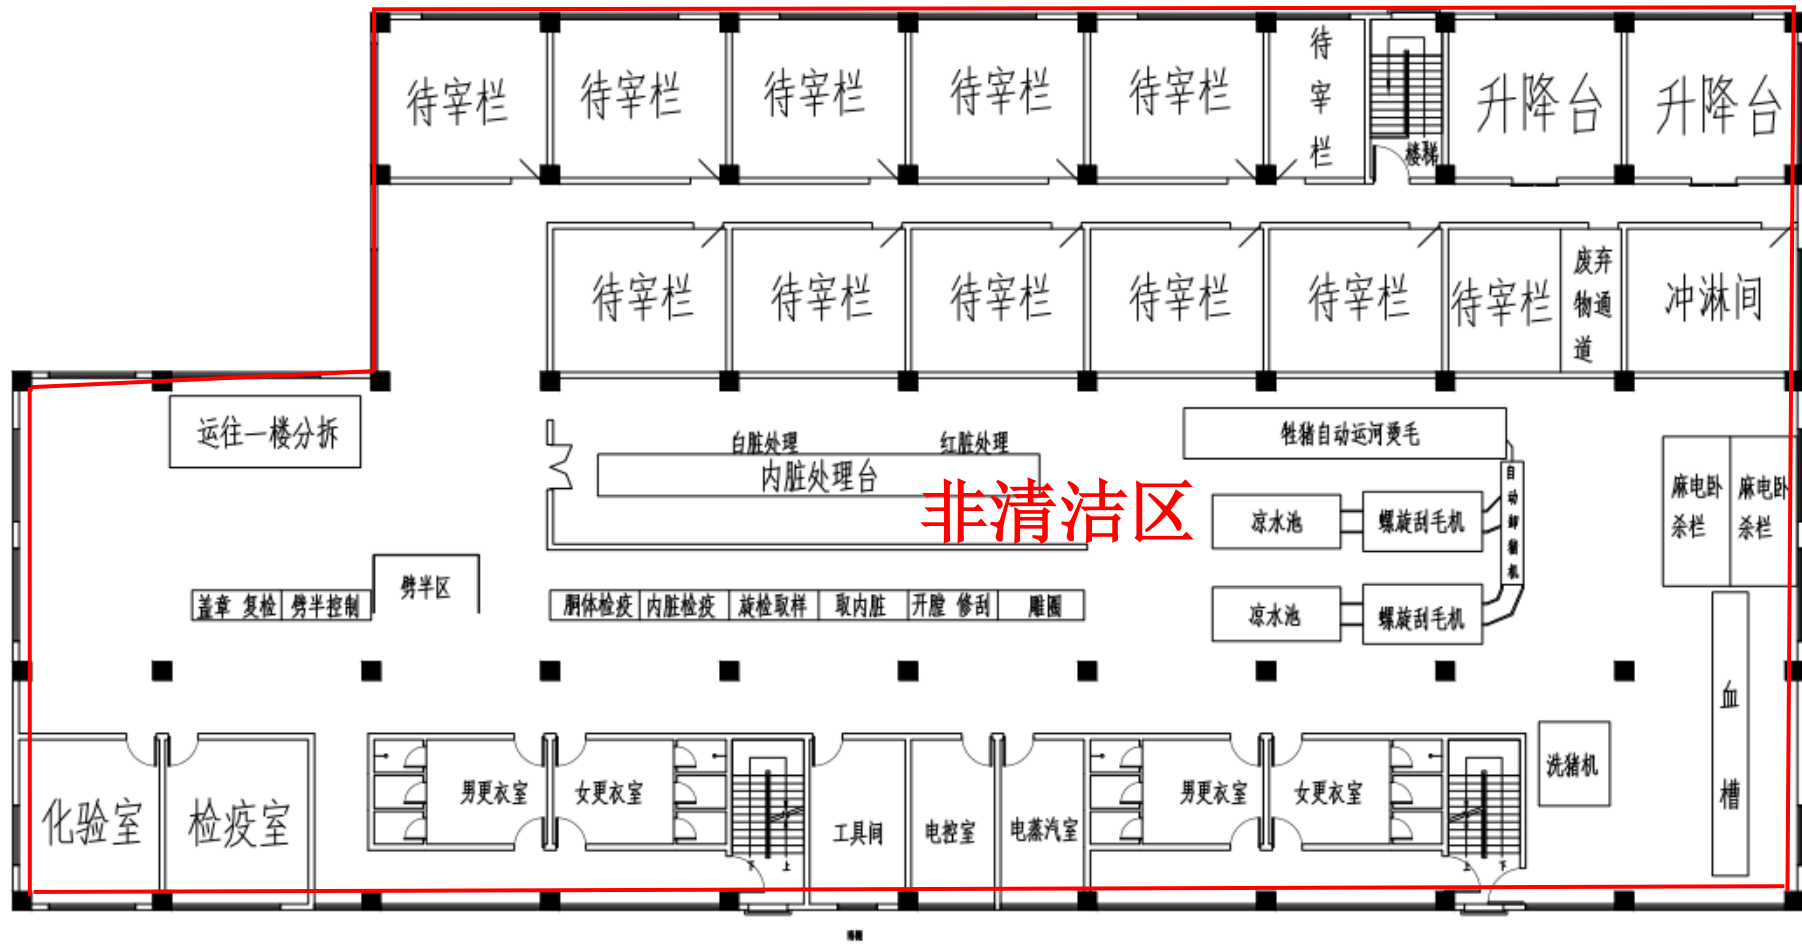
生猪屠宰车间 2 楼平面布置图
